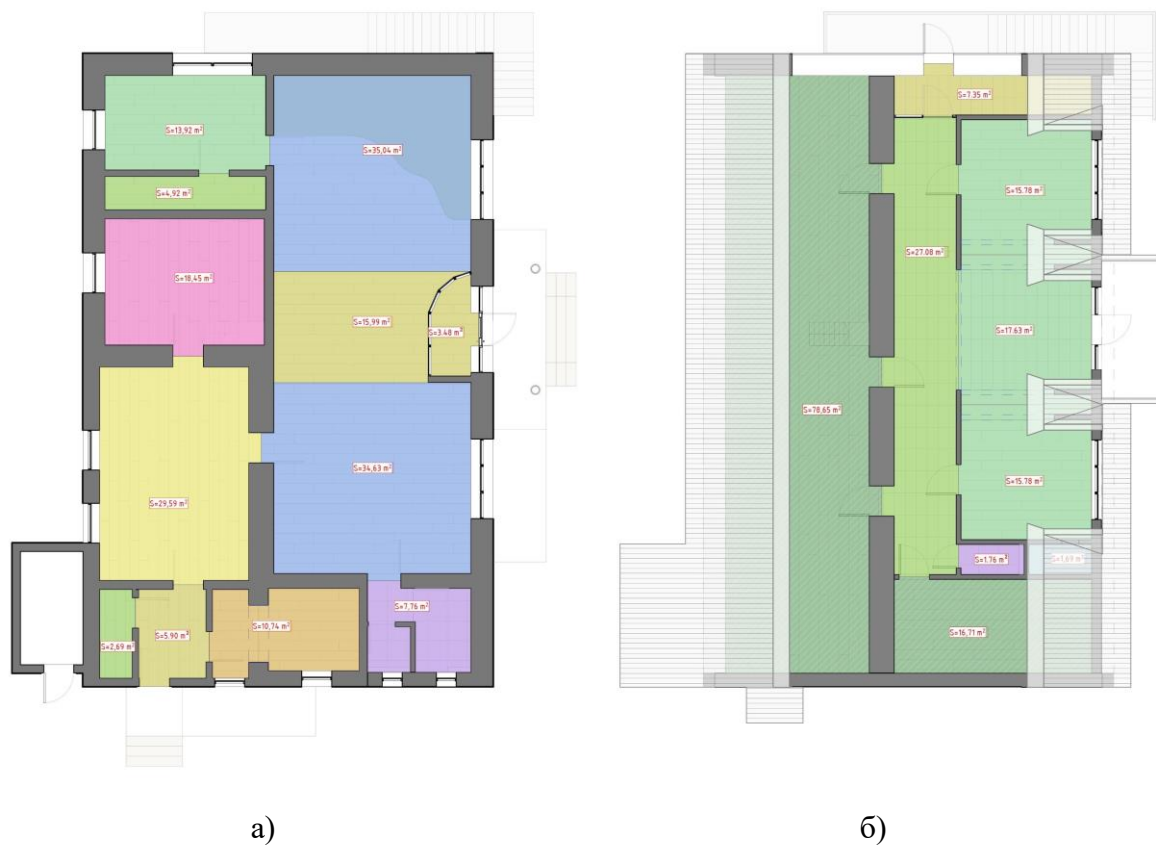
Плани зонування: а) першого поверху; б) другого поверху
